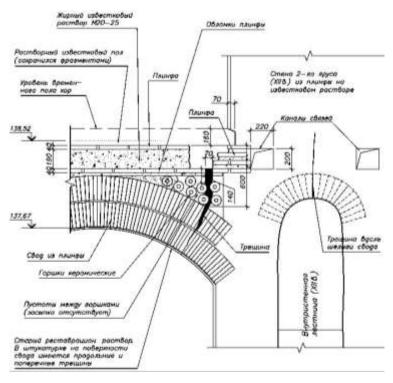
Трещина в верхней зоне свода перекрытия 1-го яруса и конструкции пола на хорах
